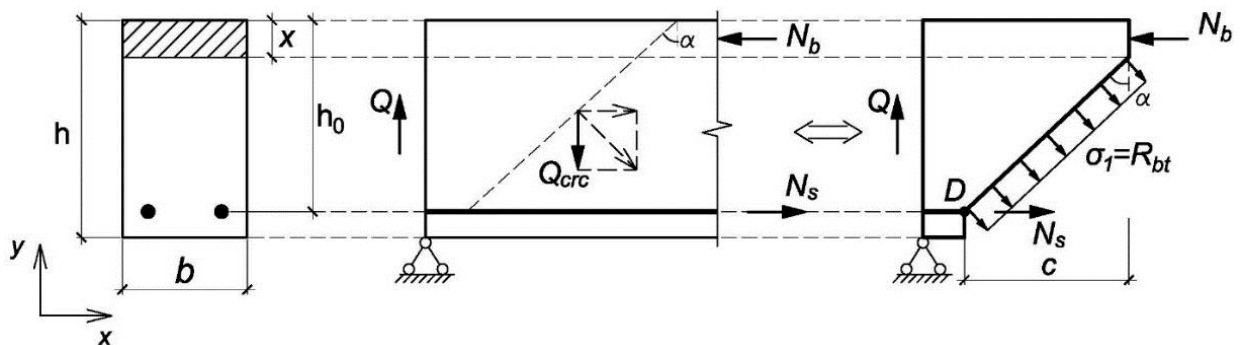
Равновесие участка железобетонной балки при образовании наклонной трещины
